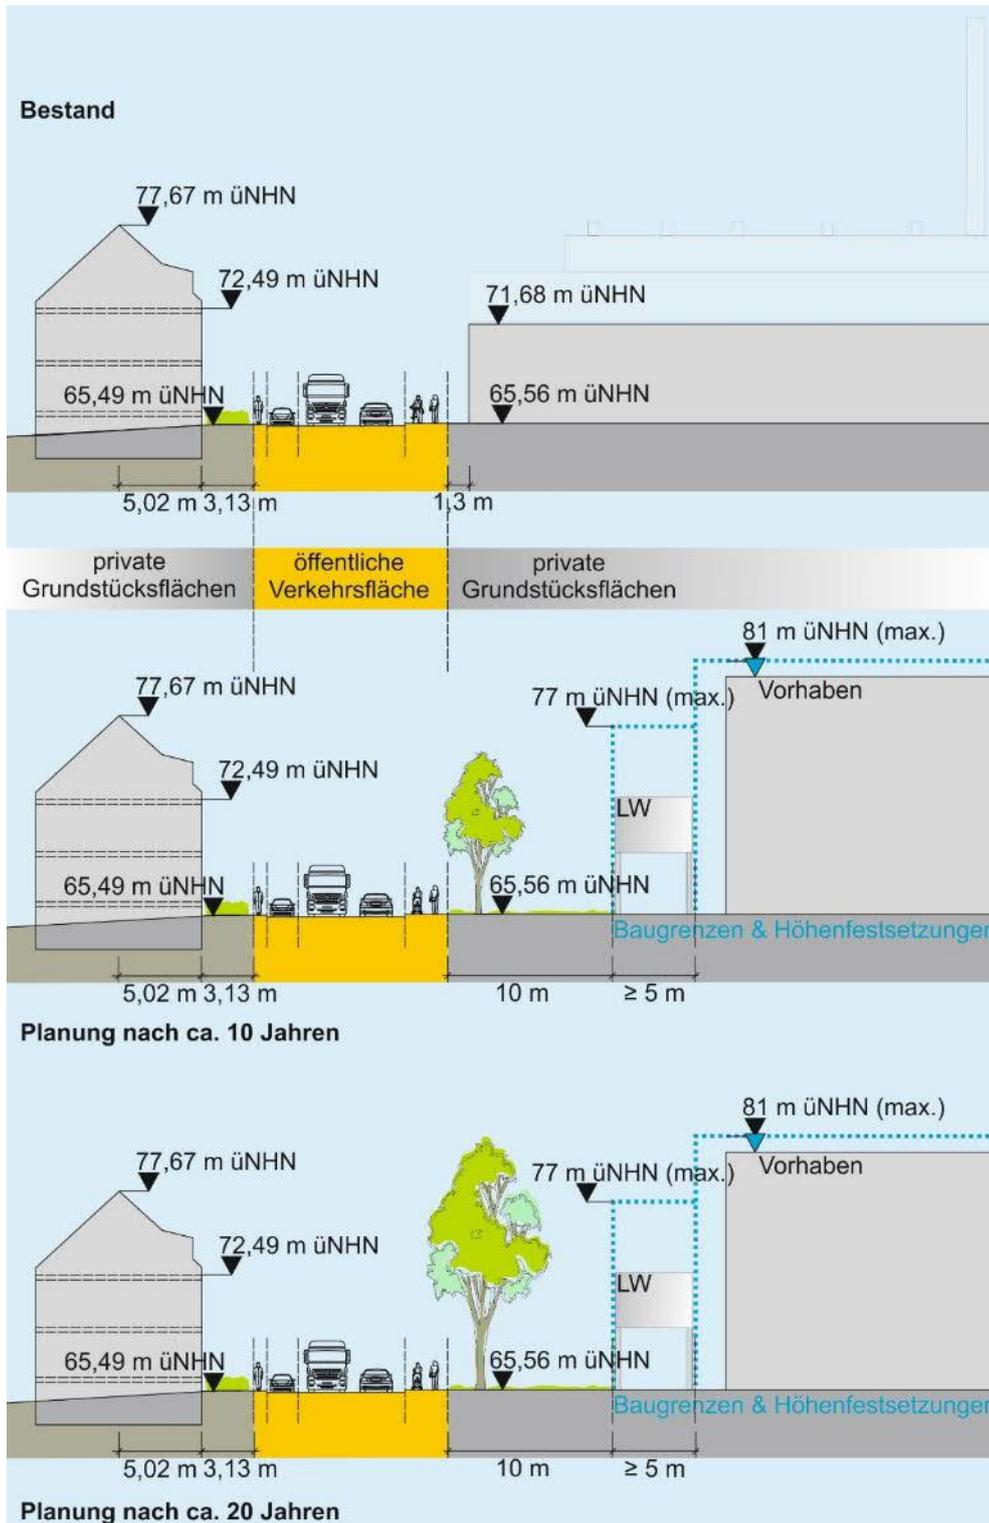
Schnitt Bestand und Planung nach ca. 10 sowie nach ca. 20 Jahren im Bereich Dülkener Straße 163-169 (unmaßstäblich)¹² (LW = Löschwassertank / -zisterne)
